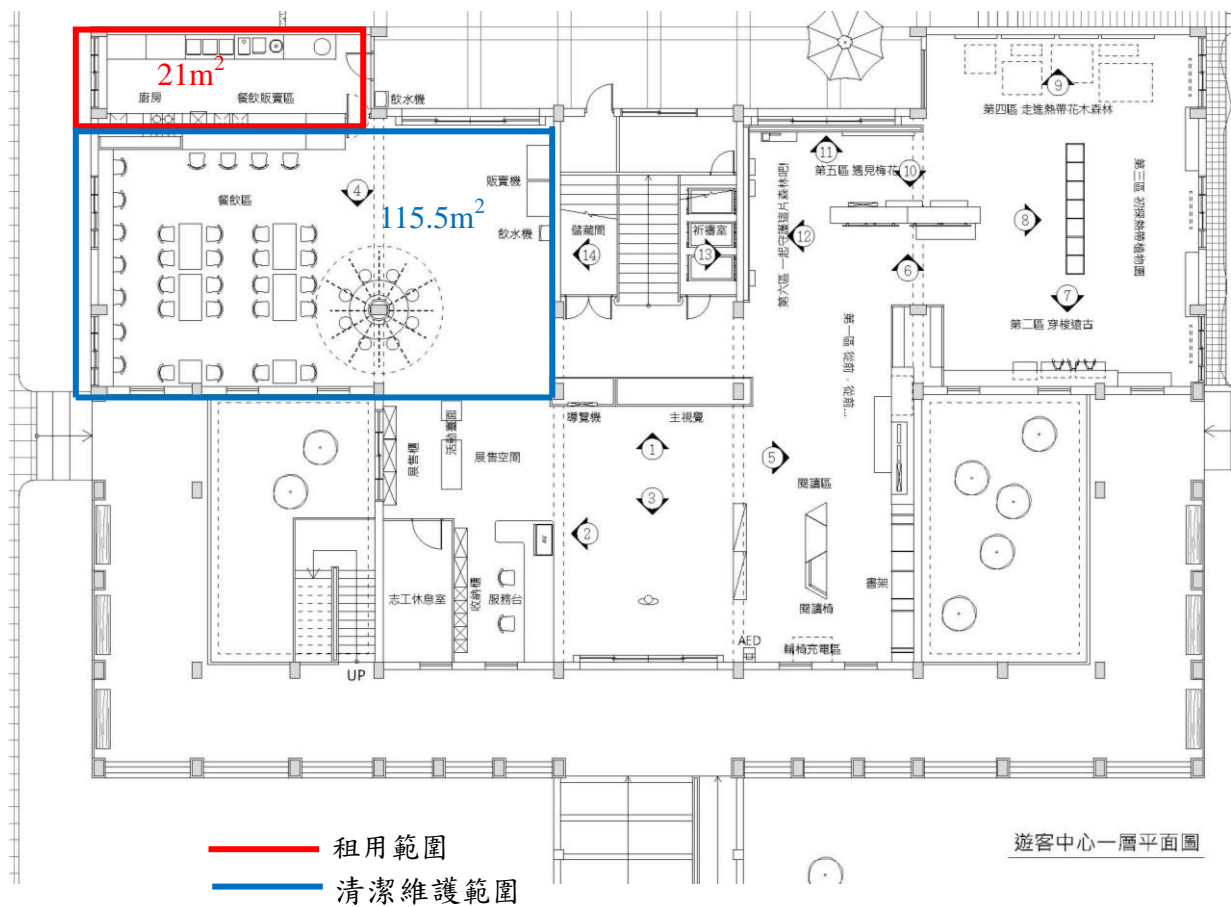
遊客中心 1 樓平面圖(備註:以上平面圖僅供參考,實際尺寸依建築現況為主)
